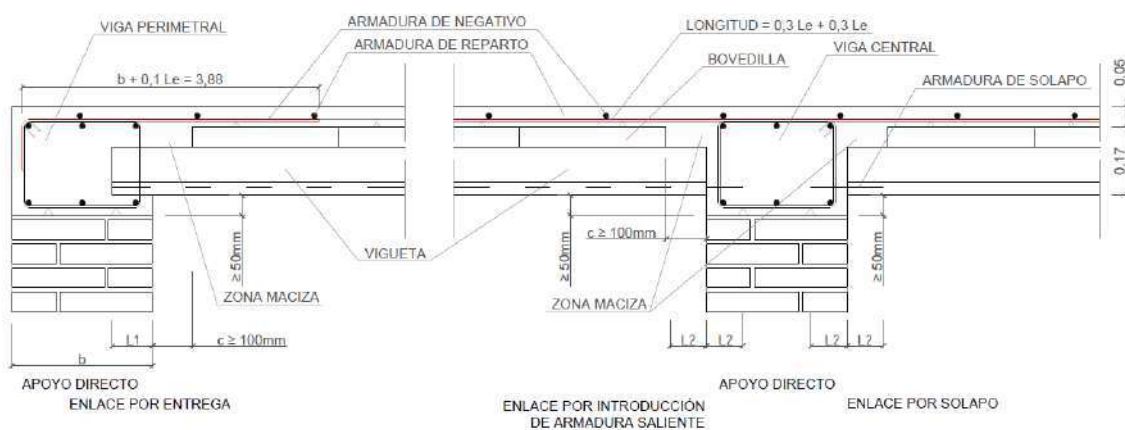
Detalle de forjado unidireccional sobre muro de ladrillo. 2016. Fuente Propia
